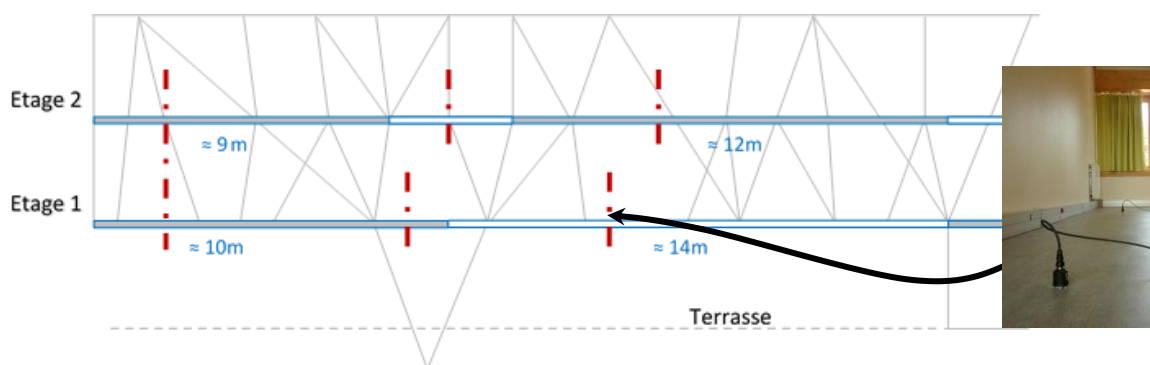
Coupe longitudinale et zones d'essais (en rouge) avec détail d'un accéléromètre
